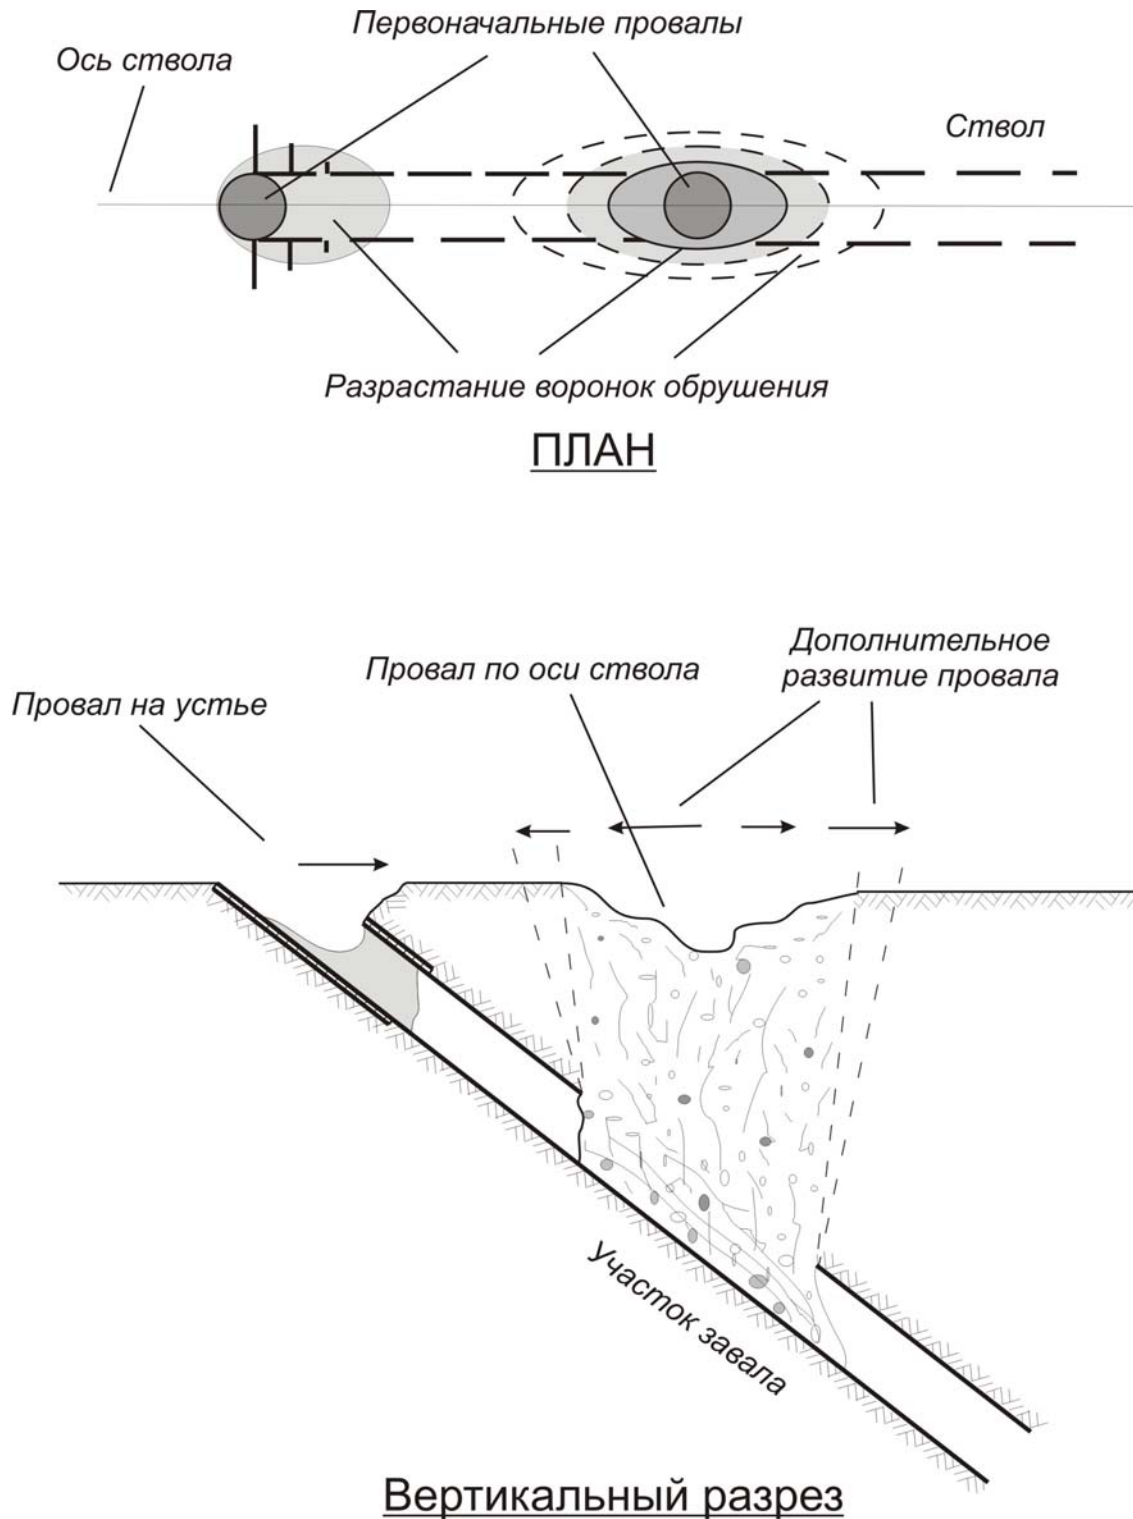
Общая схема развития провалообразований над наклонными стволами
